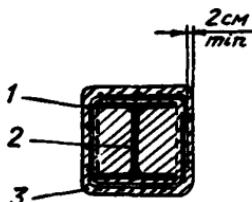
Усиление стального профиля с помощью торкрет-бетона:
